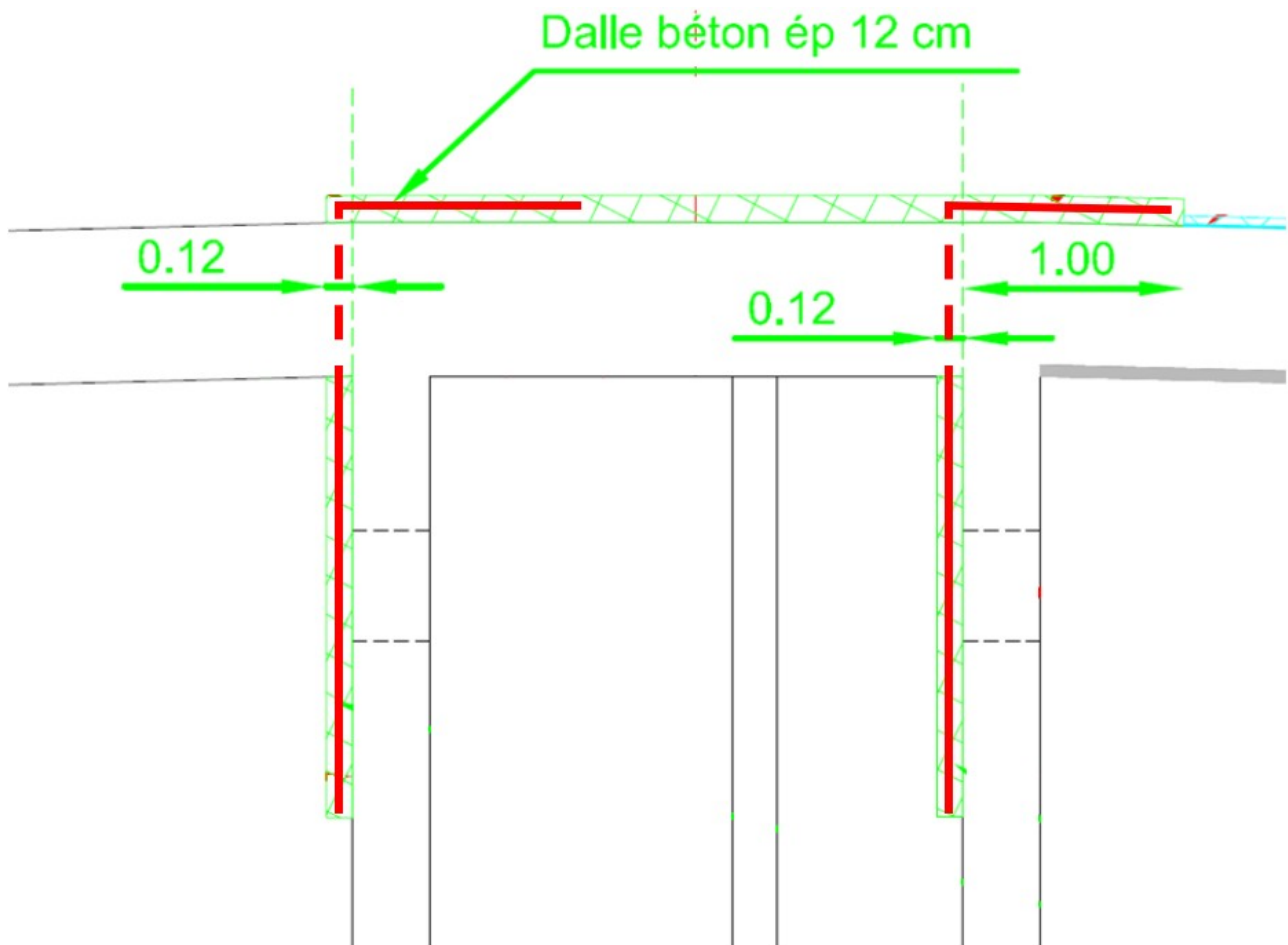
Représentation des aciers de renfort principaux des piédroits centraux (aciers traversant la dalle)
